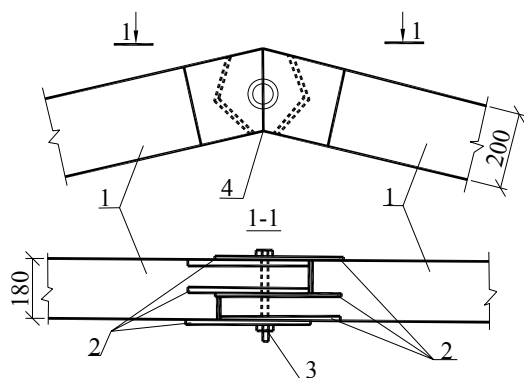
Конструкция конькового шарнира [151]: 1 – ригель полурамы; 2 – закладные детали; 3 – болт МЗО; 4 – ось шарнира
